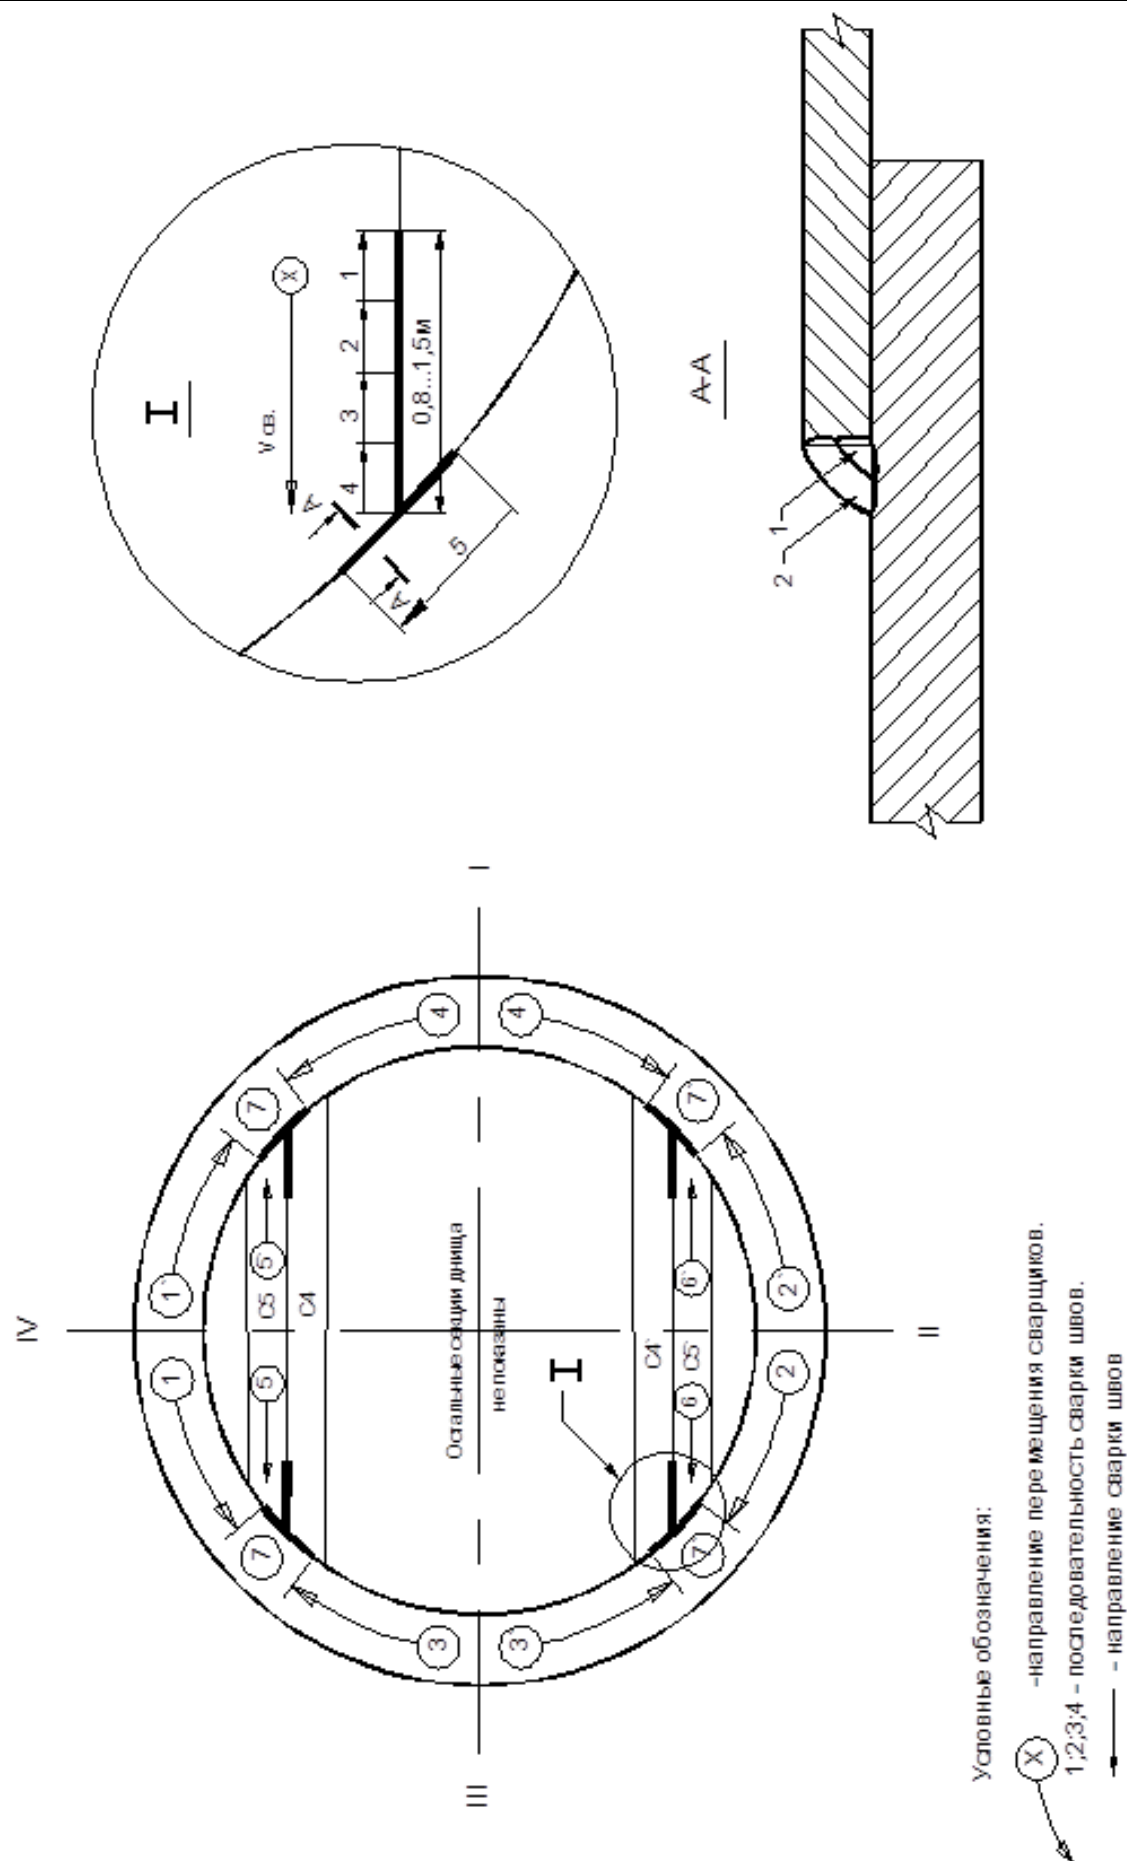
Схема сварки центральной части днища с кольцом окраек
